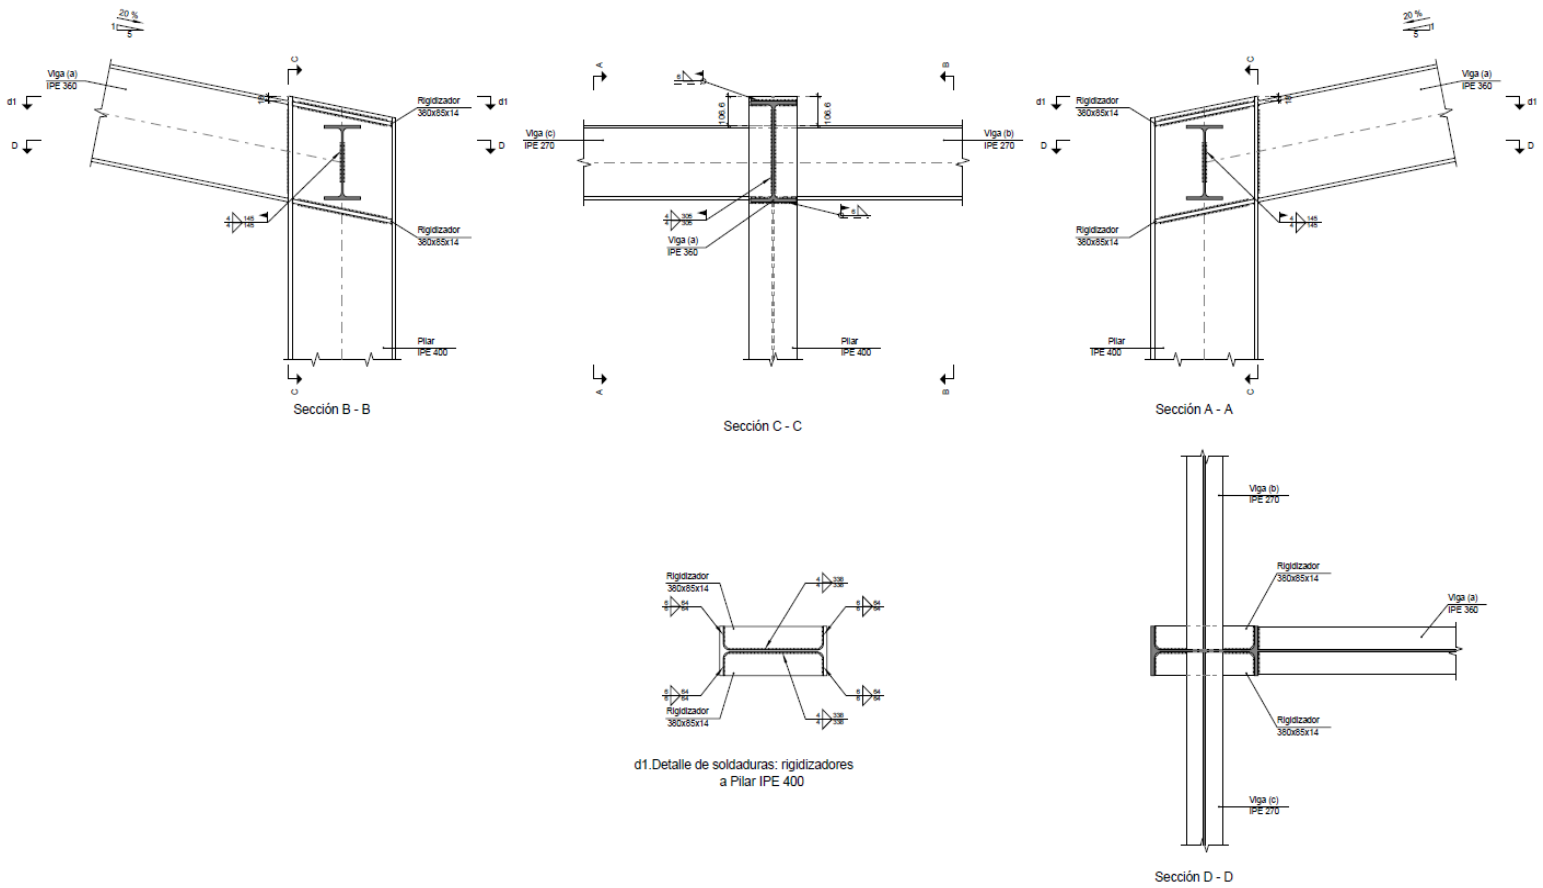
Detalle unión Pilar-Viga de atado-Dintel
